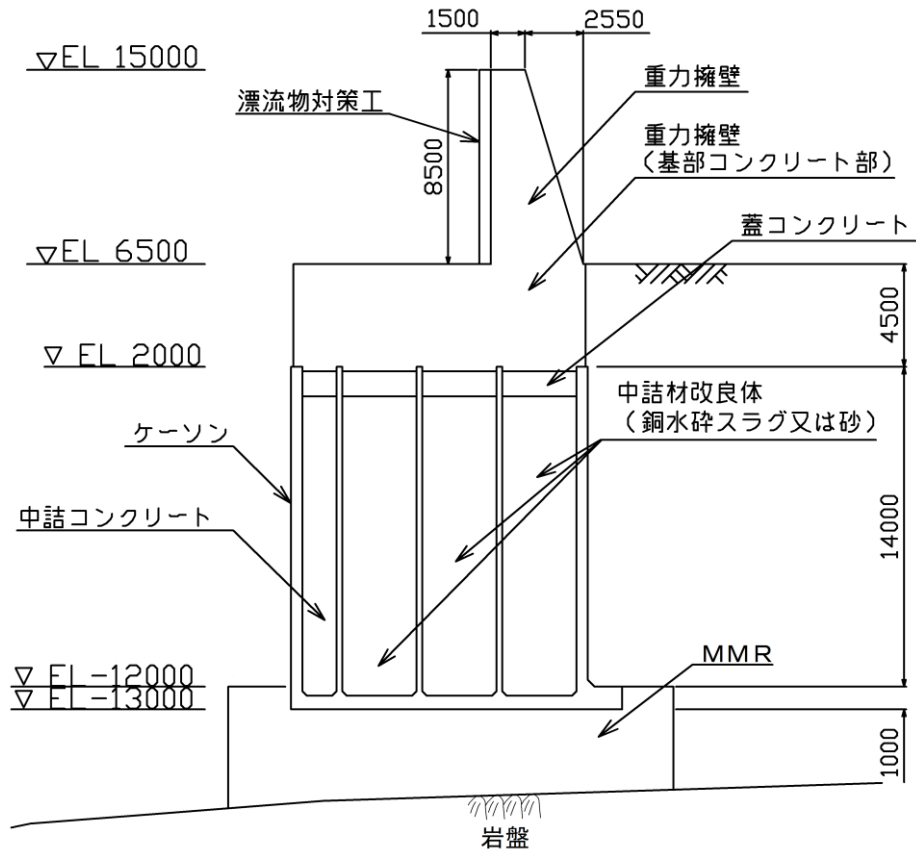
(2) 防波壁（波返重力擁壁）の構造図（ケーソン設置部）（断面図）
